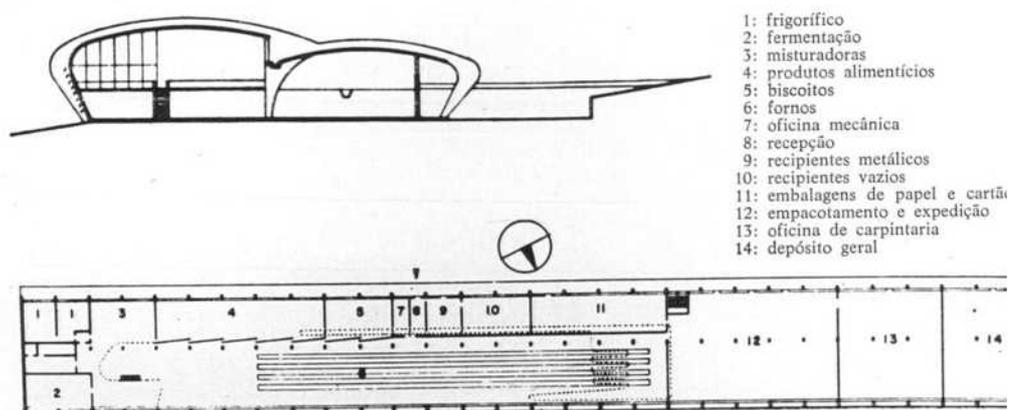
Corte e Planta Baixa da DUCHEN, 1950.
